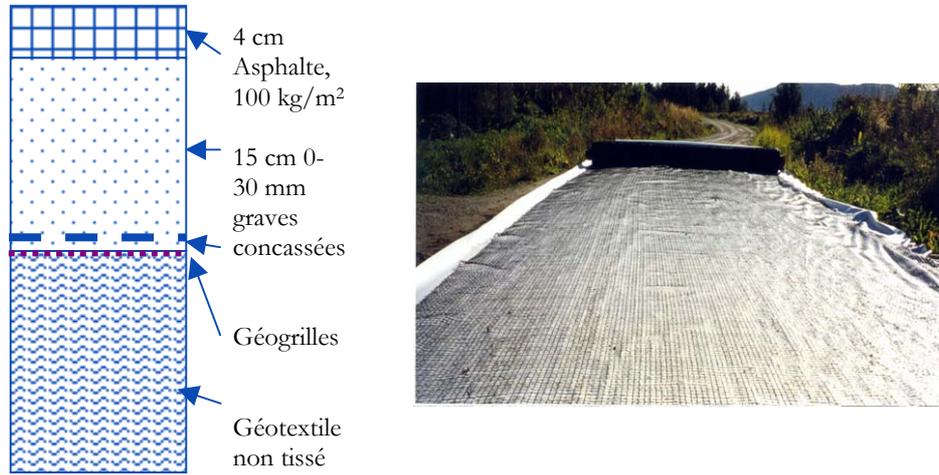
Installation de géogrilles pour le réhabilitation d'une chaussées (Watn et Øiseth, 2000)
